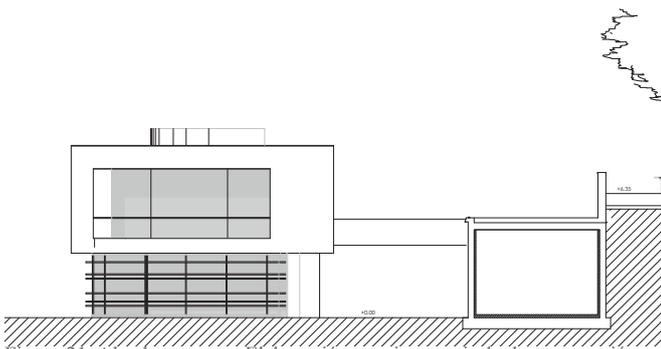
Alzado suroeste. Elaboración propia a partir de documentación aportada por Fernando Sánchez Navarrete
